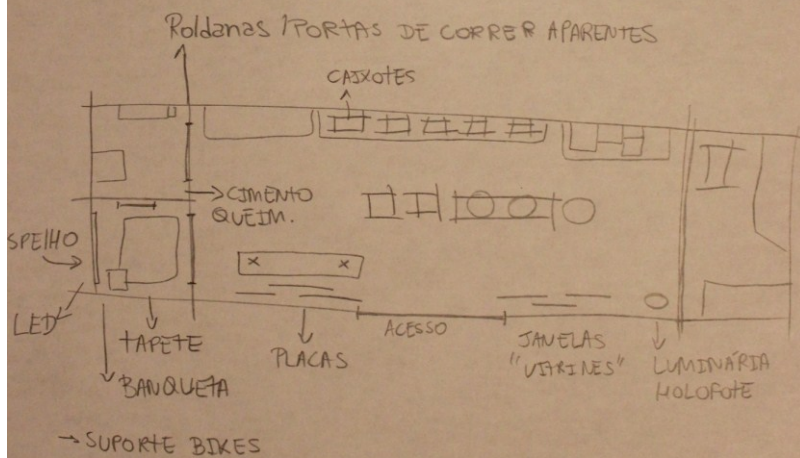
, 64, 65, 66 e 67: Estudos de layouts
